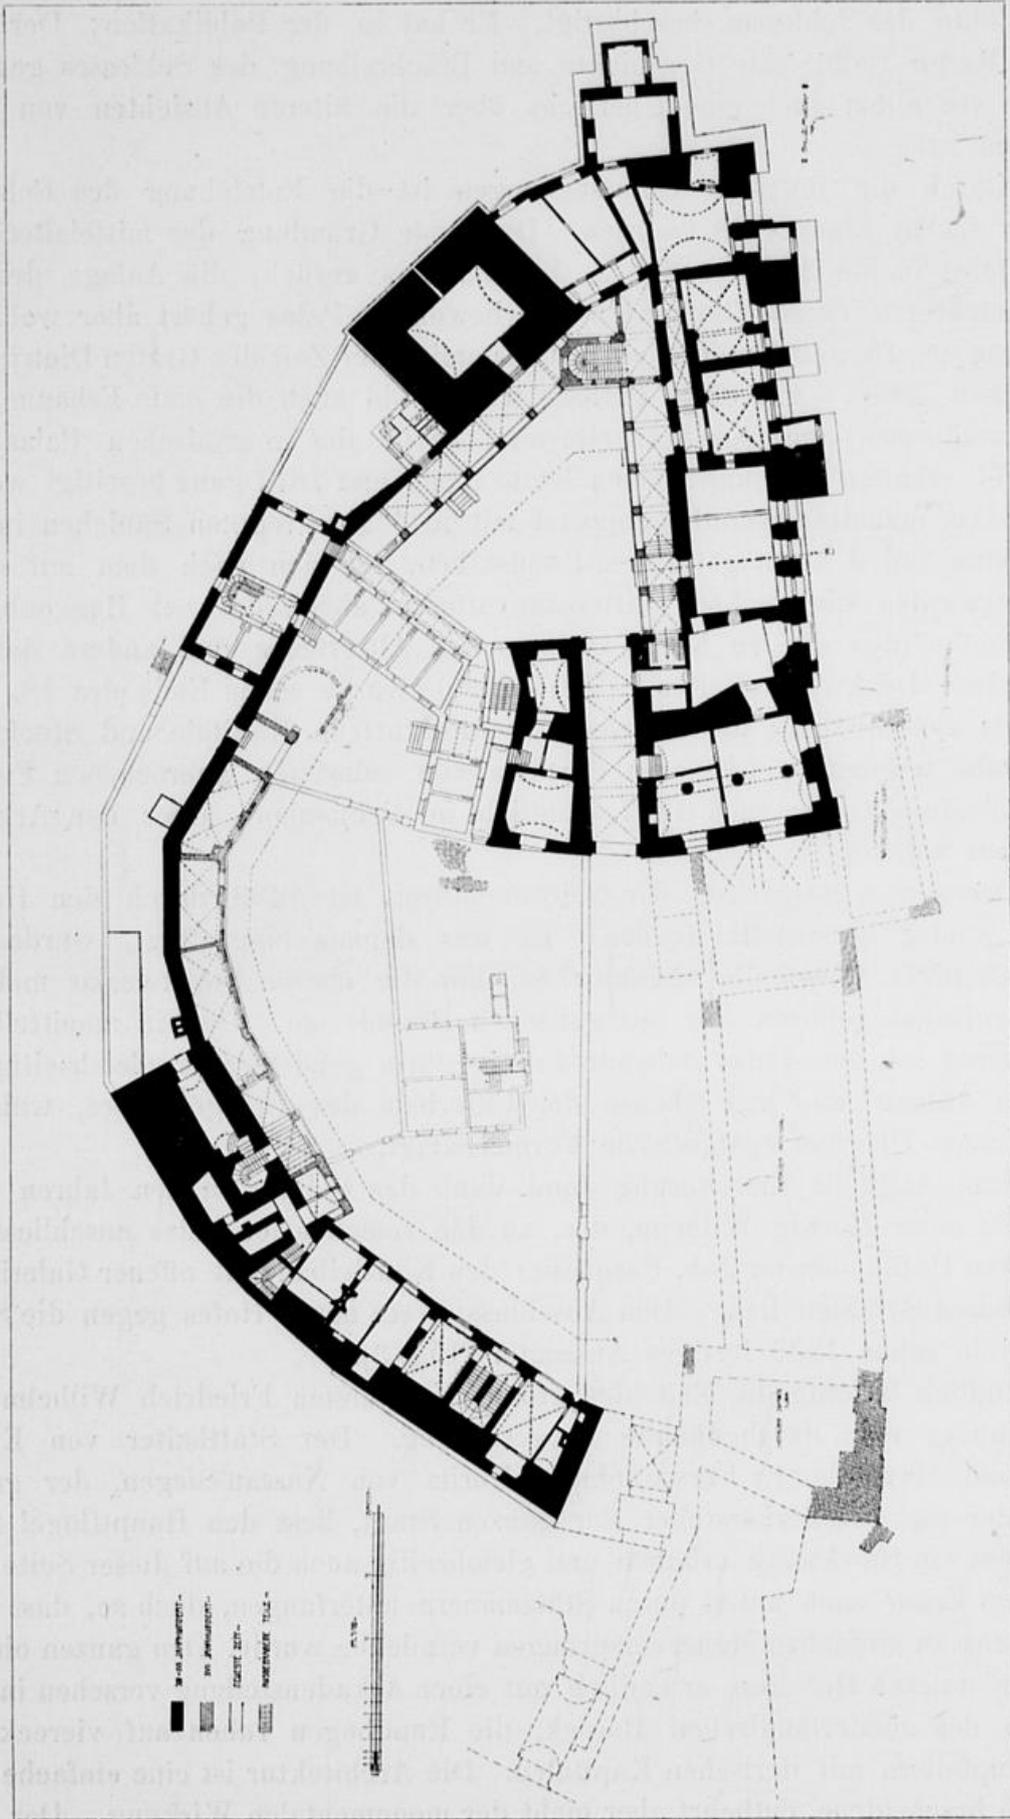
Cleve, Schloss. Grundriss des Erdgeschosses mit den Ausgrabungen. (Aufn. von J. Müller, 1909.)
